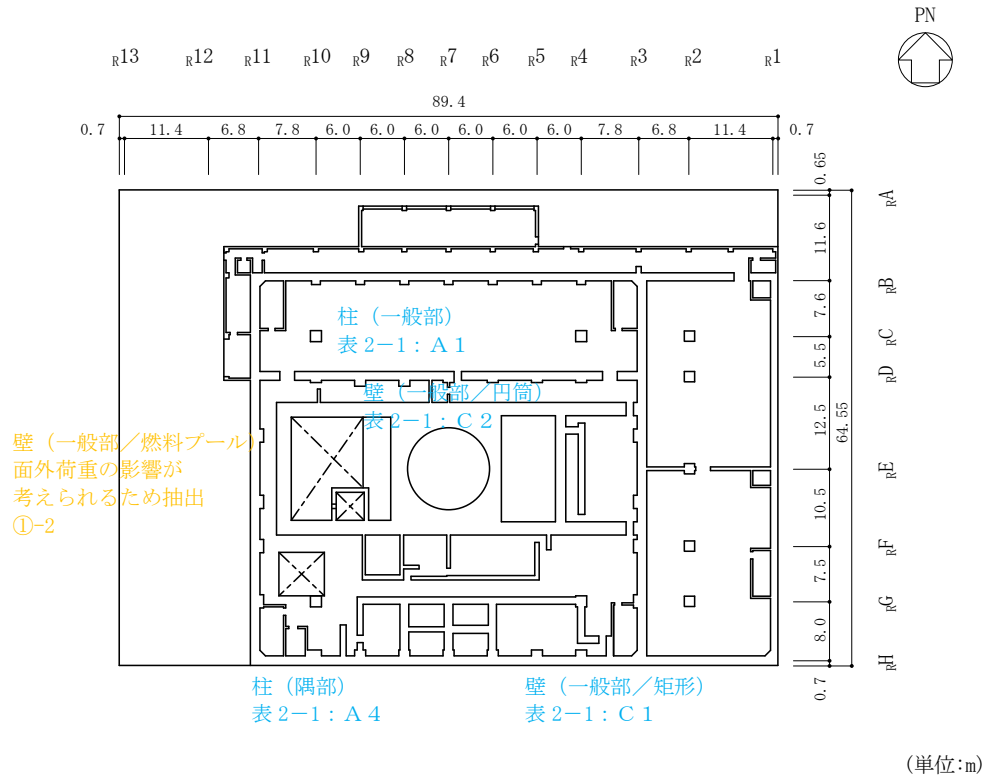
(6) 原子炉建物の概略平面図 (EL 34.8m)
